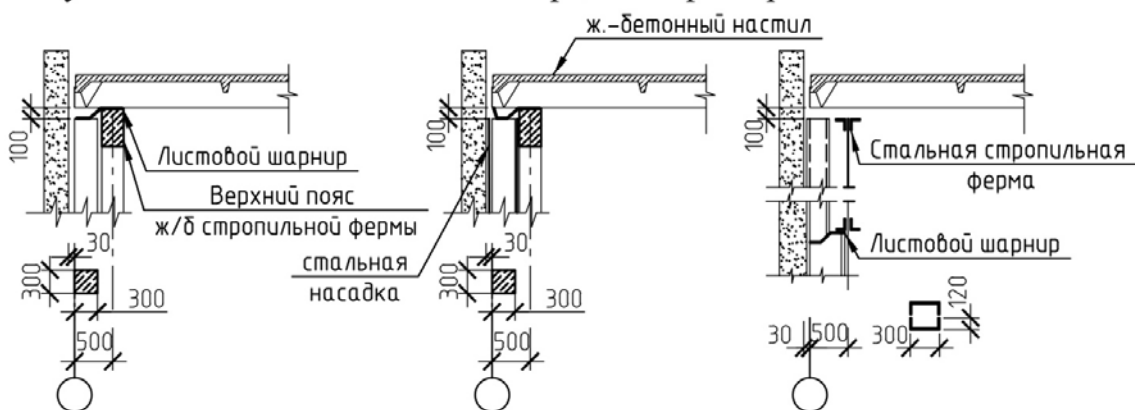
Схемы крепления колонн торцевого фахверка к несущим конструкциям покрытия
